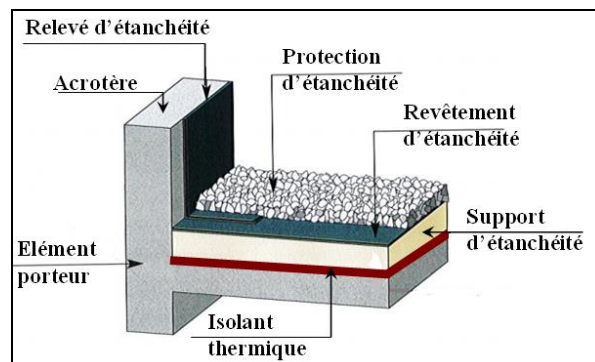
Composition d'une toiture-terrasse (Remolu et Lauby, 2007)
